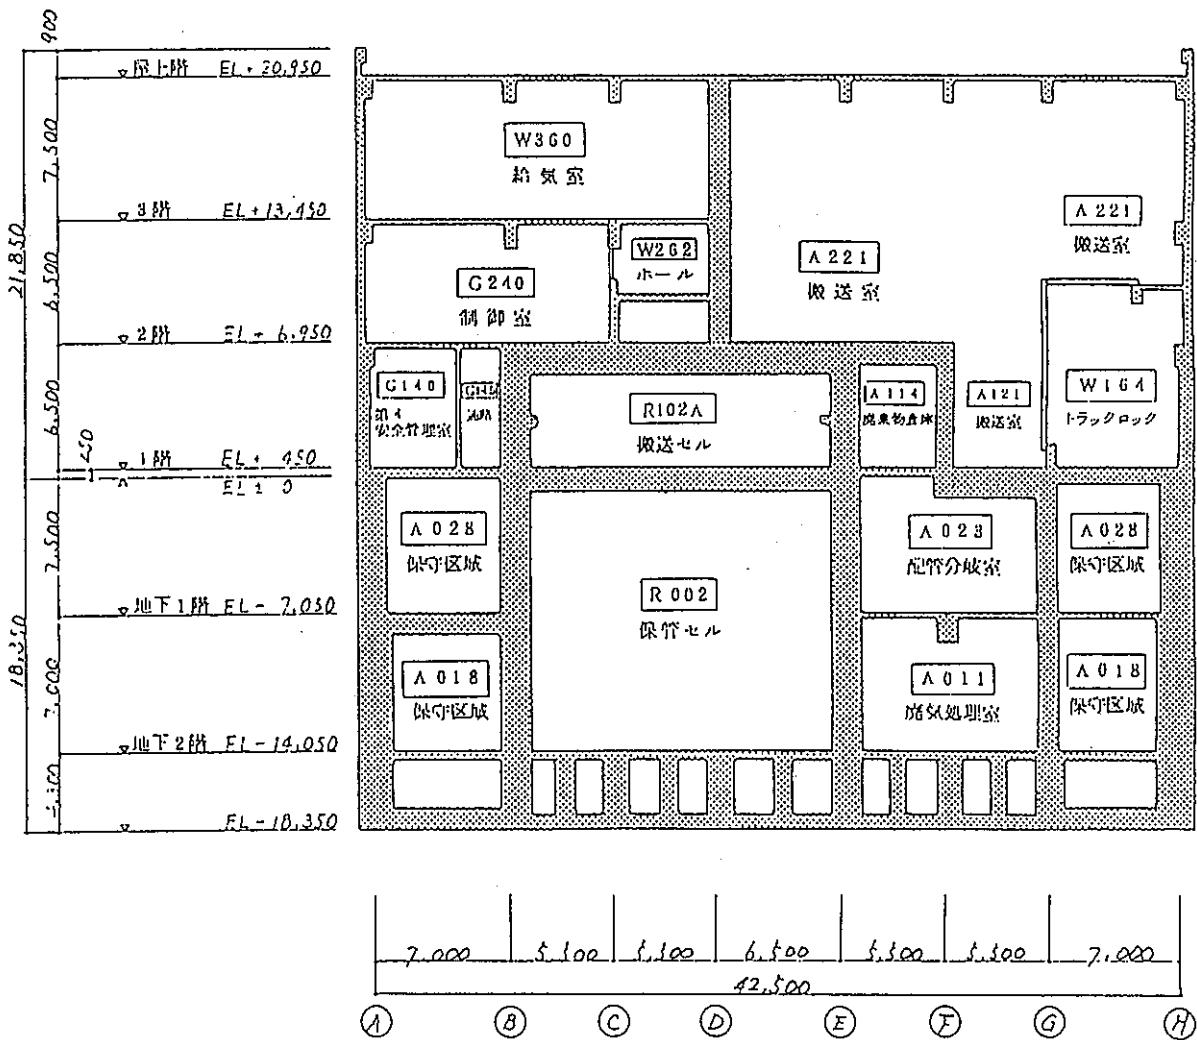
ガラス固化技術開発棟 断面図(3)
